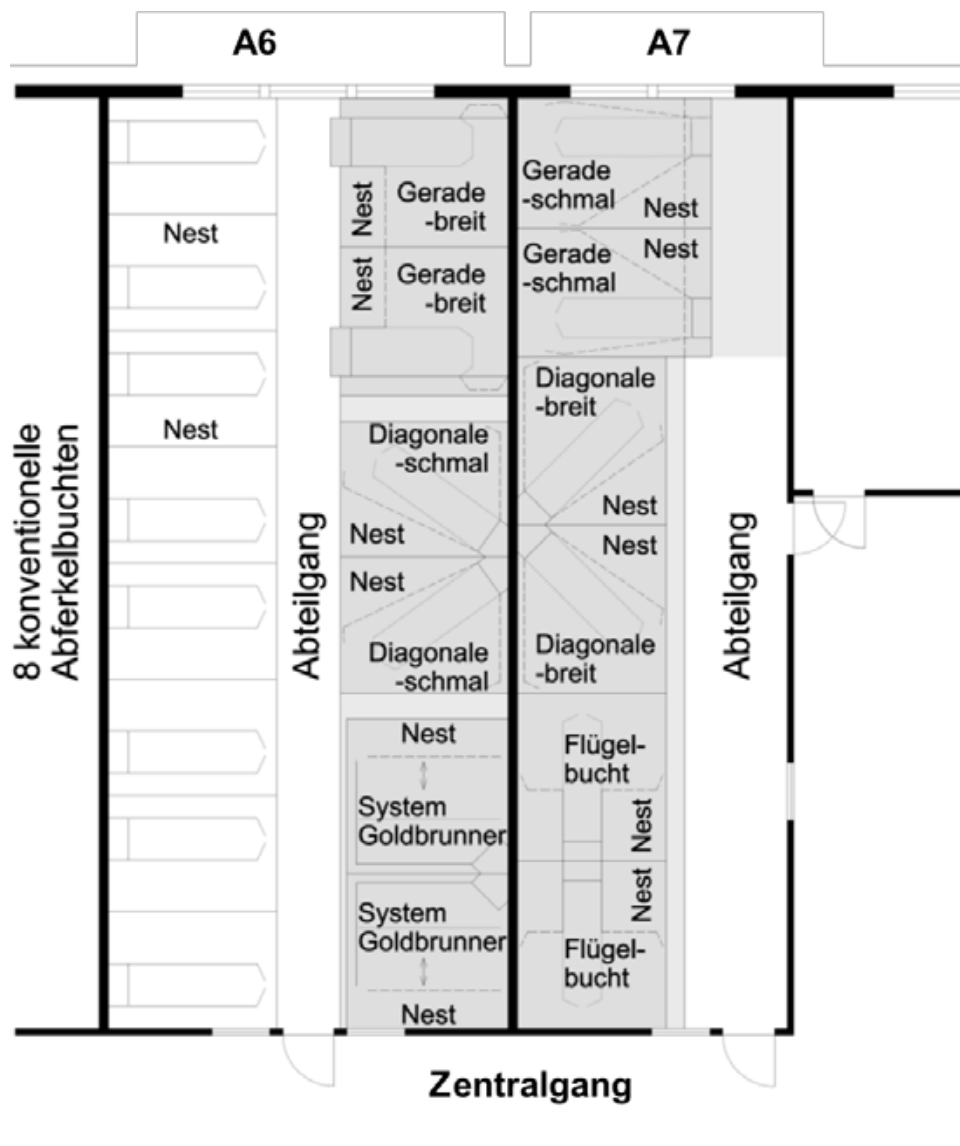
Grundriss der Abferkelabteile mit Bewegungsbuchten
